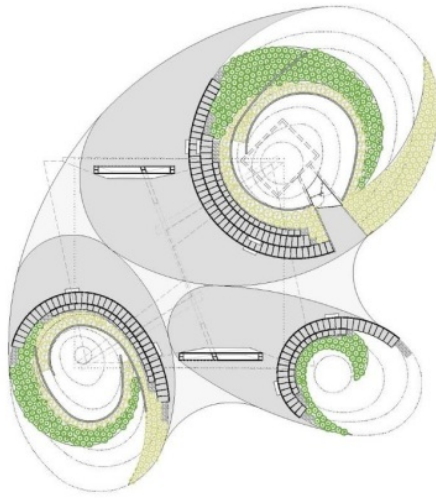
Planta MPavilion 2018, Fuente ([www.cpinos.com](http://www.cpinos.com))
